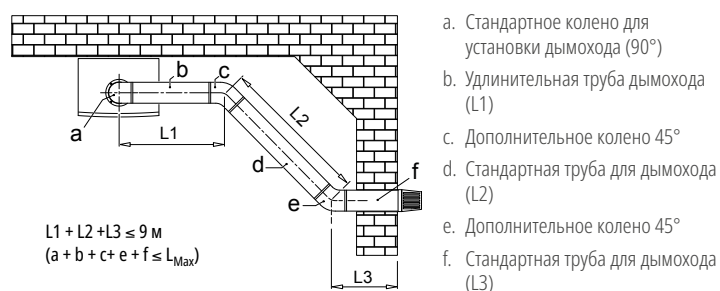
III. Образец установки дымохода конденсационного котла с одним коленом 90° и двумя коленами 45°
